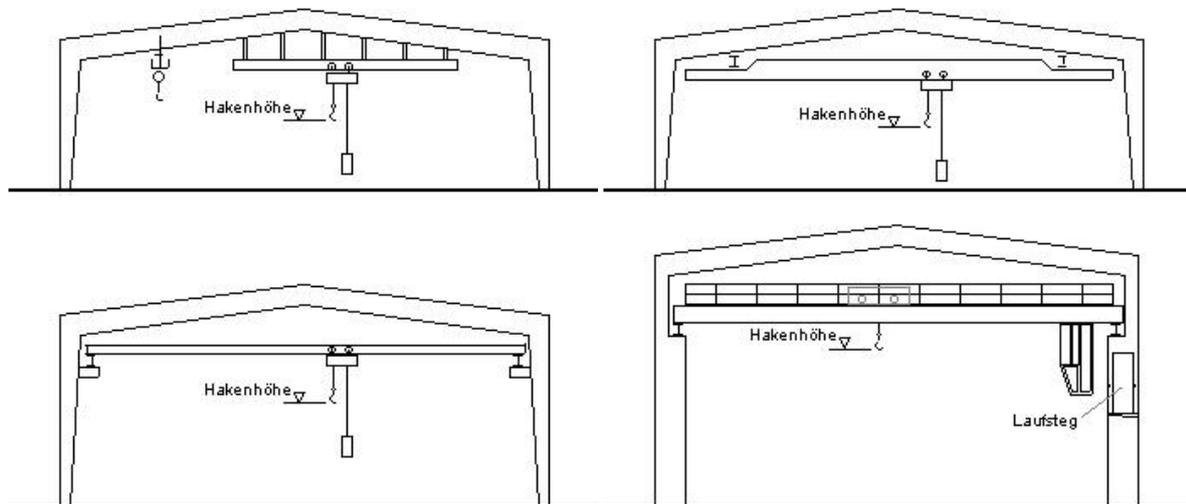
Grundsätzliche Ausführungsbeispiele für Hallenkrane
